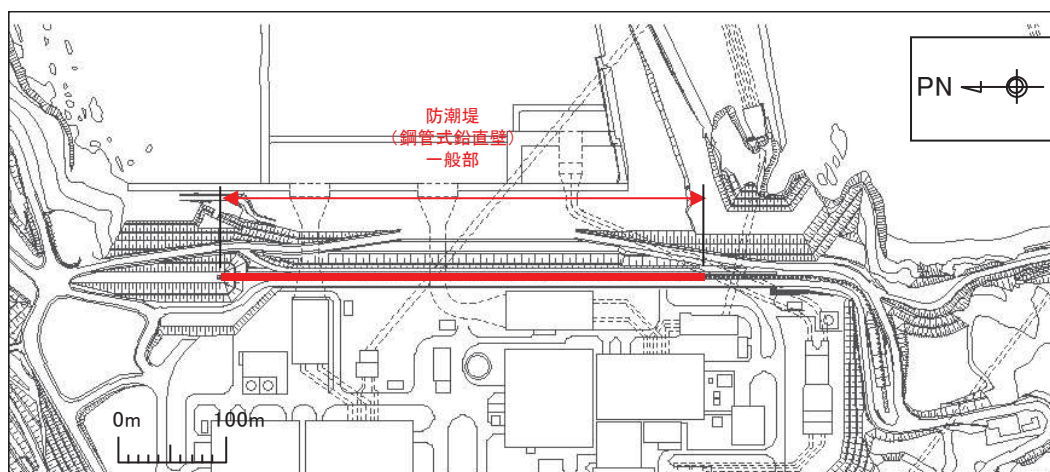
鋼管式鉛直壁（一般部）の平面配置図
